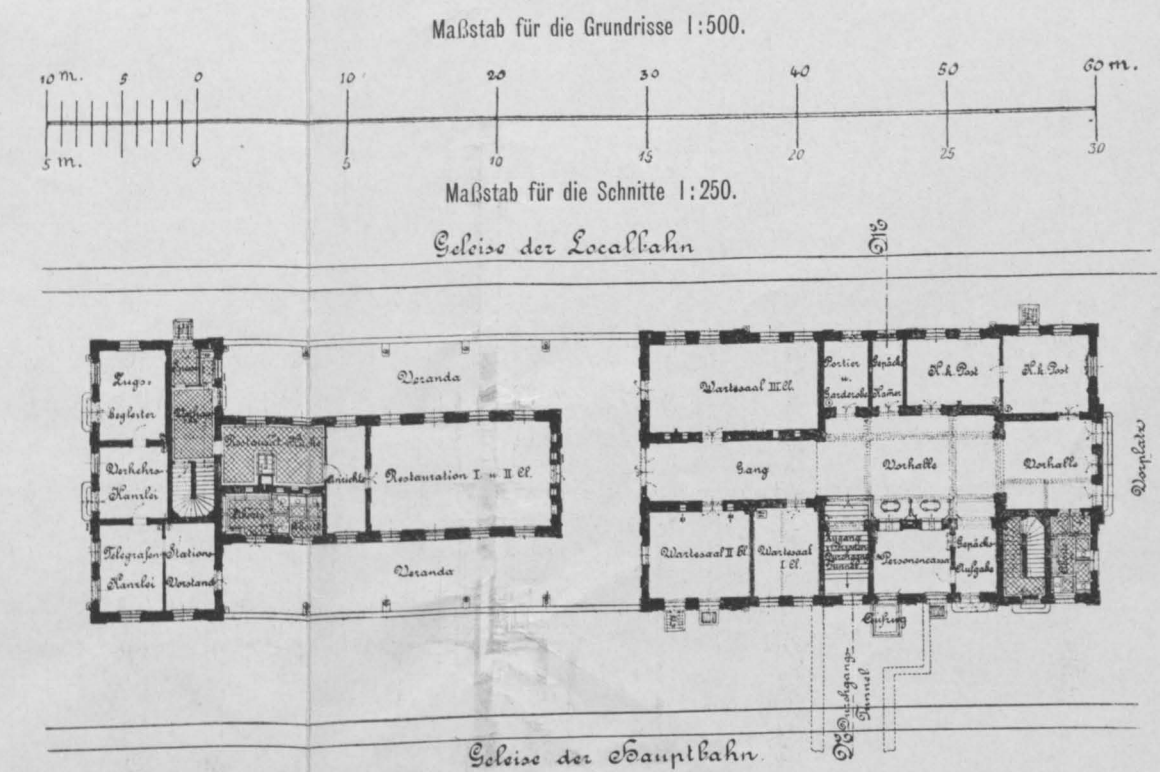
Grundriss des Aufnahmegebäudes in Zauchtel. 1:500.
